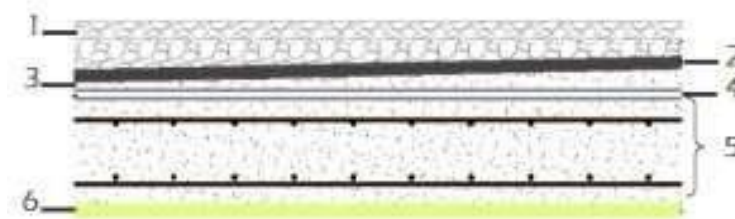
Coupe d'un plancher en dalle pleine (inaccessible)
